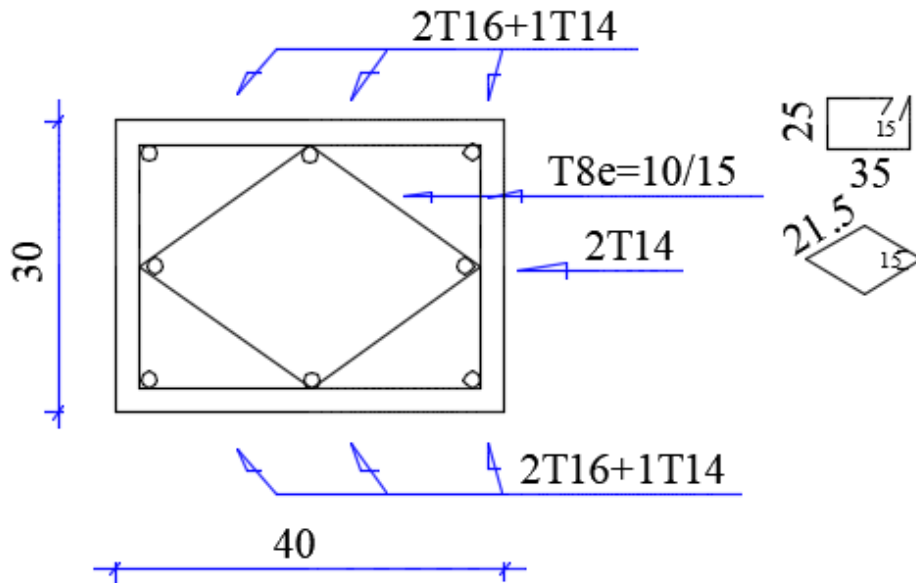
Ferrailage du poteau rectangulaire (30x40) cm<sup>2</sup>
